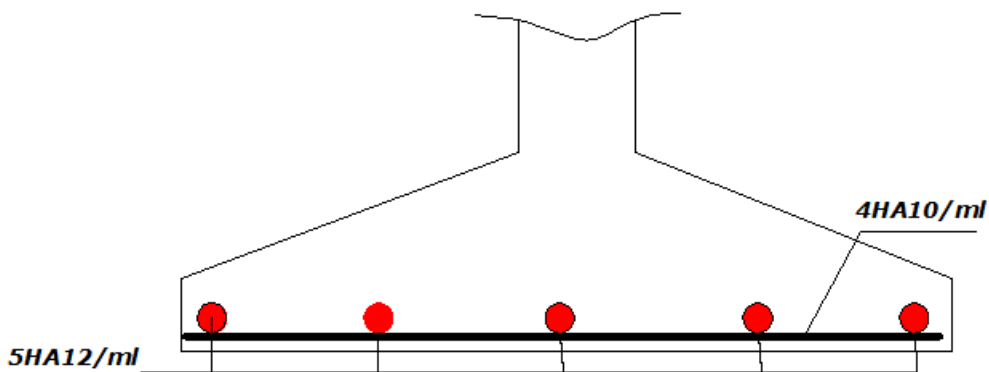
Schéma de ferrailage de la semelle filante de type (I)
